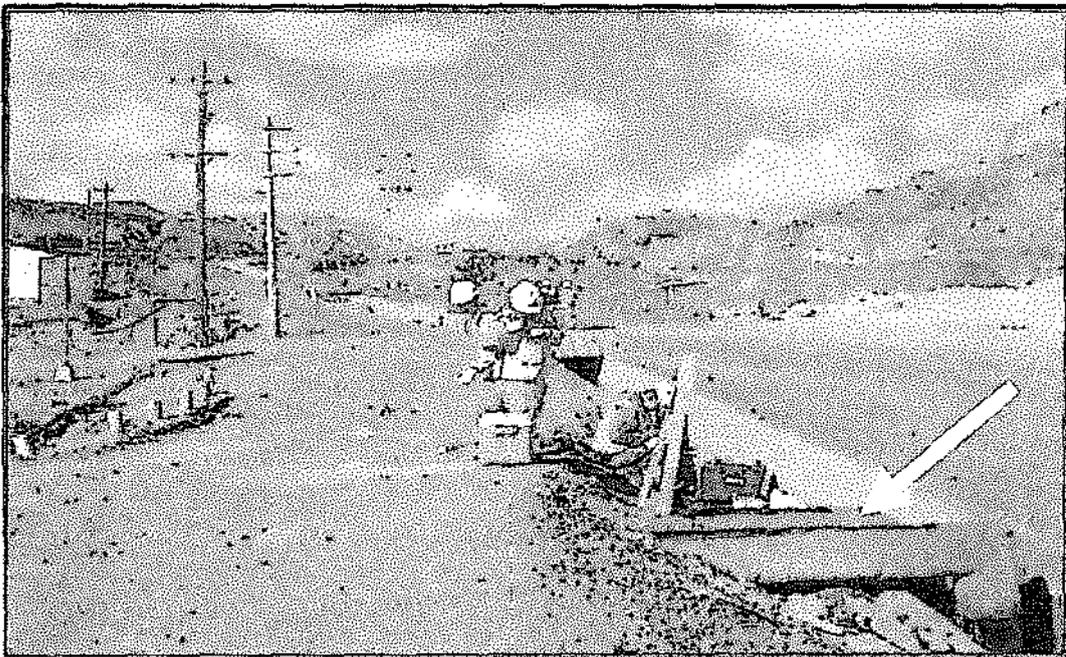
Vista del efluente P-203 de la Planta de Neutralización, con coordenadas UTM (N: 8818790; E: 0360680)
